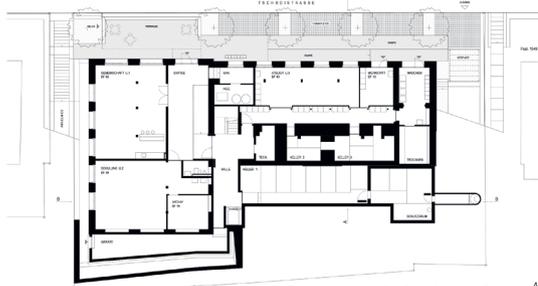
| Solinsieme. Grundriss Kellergeschoß
